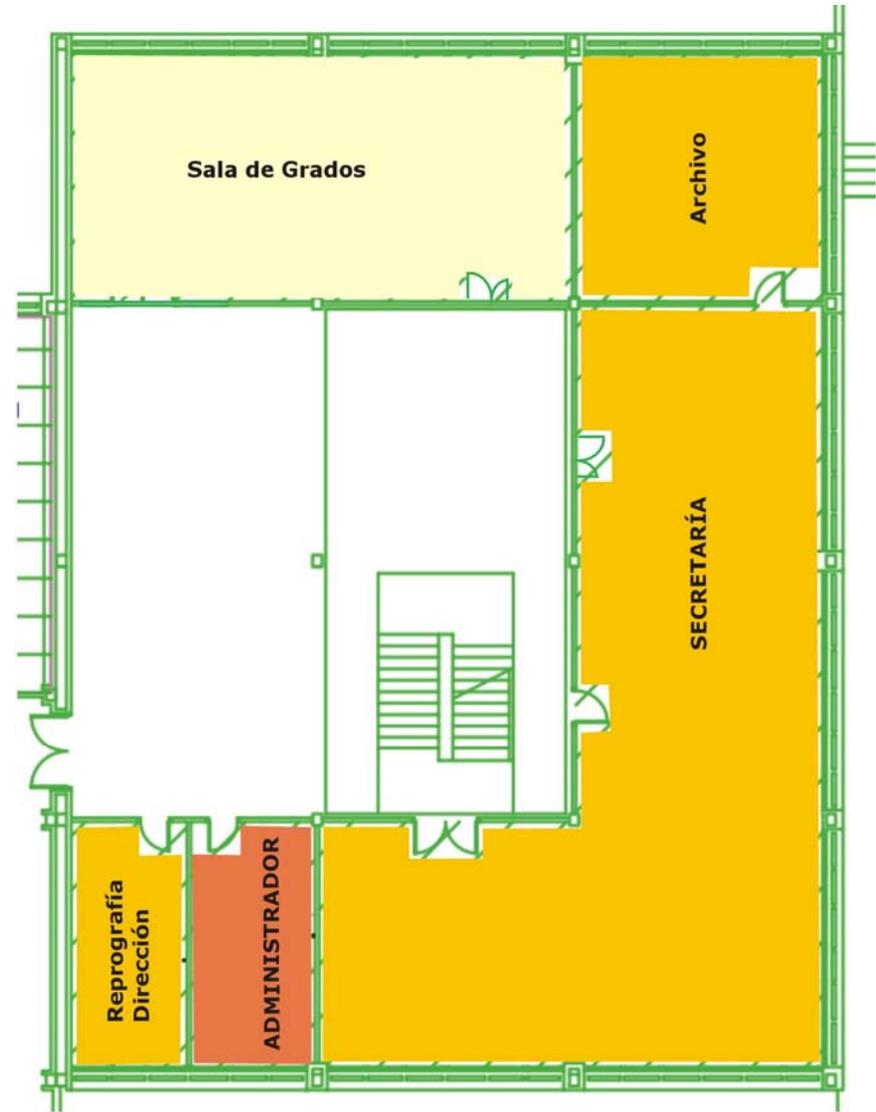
4. Plano de propuesta de actuación en Ed. Torres Quevedo (planta baja)
